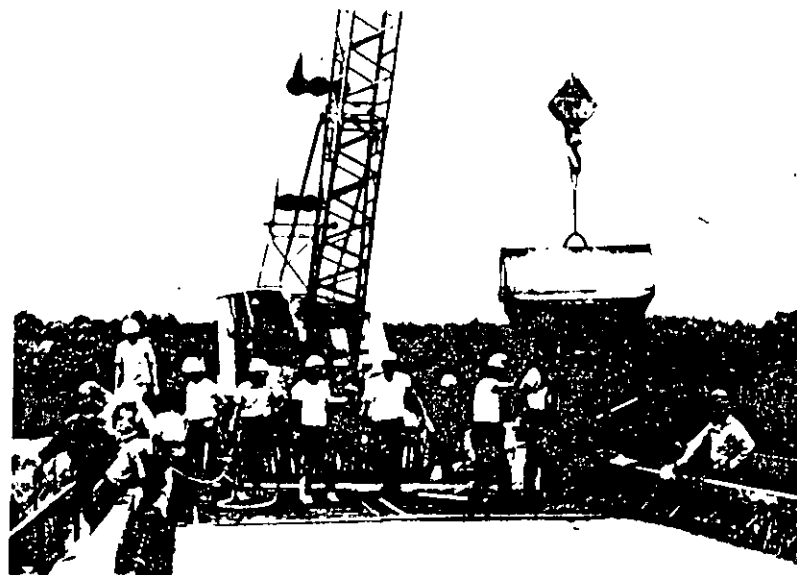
Vaciado de hormigón, mediante cubos, en un puente ferroviario.
